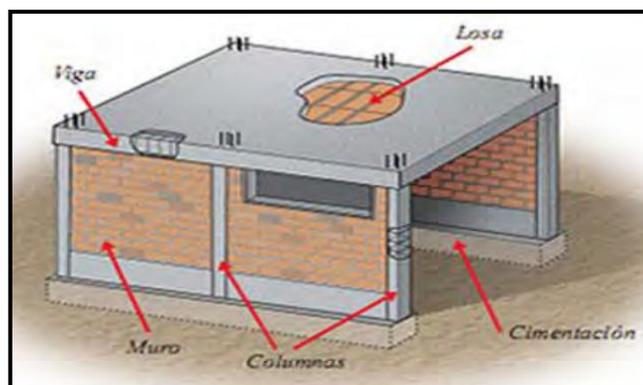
Elemento de una vivienda de albañilería confinada.
